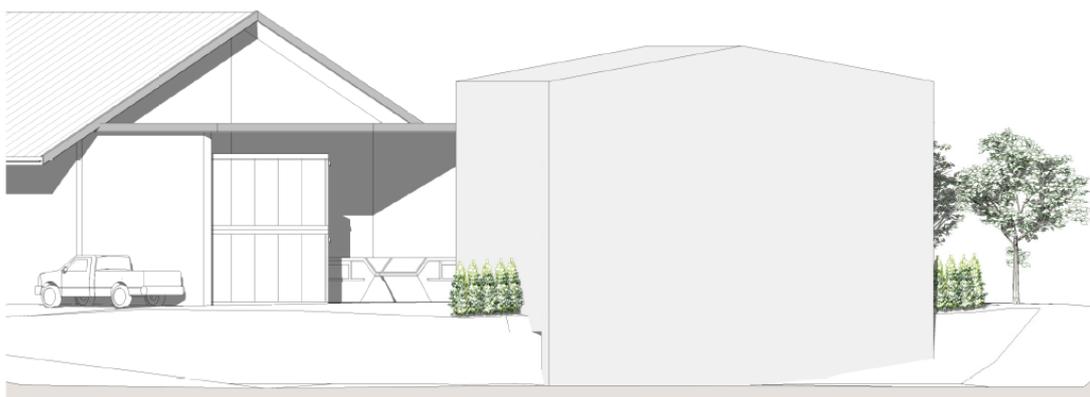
Ansicht Nord seitens des Planungsbüros m³ PLAN + BAU GmbH (ohne Maßstab)
